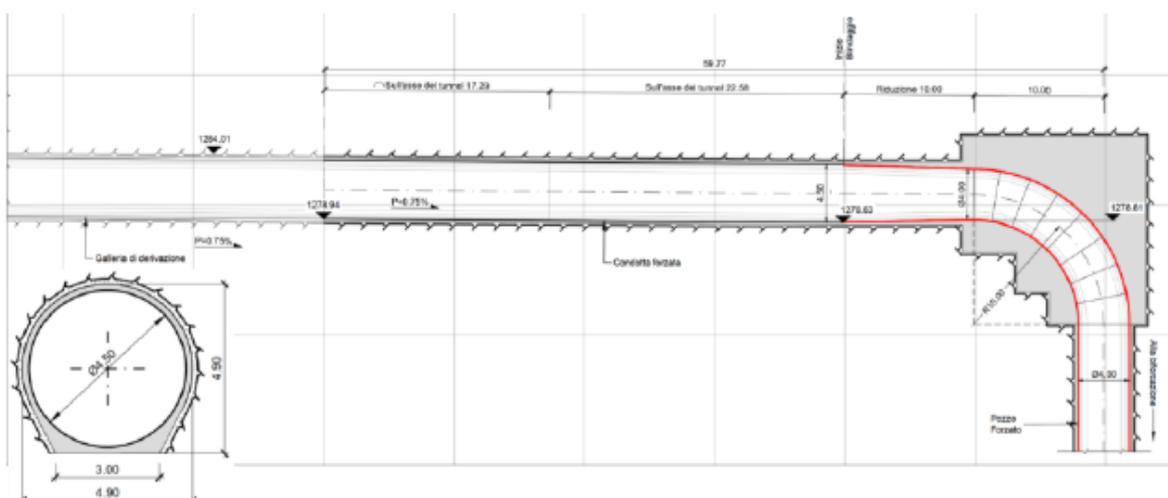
Nuova condotta forzata – profilo e sezione tipo
